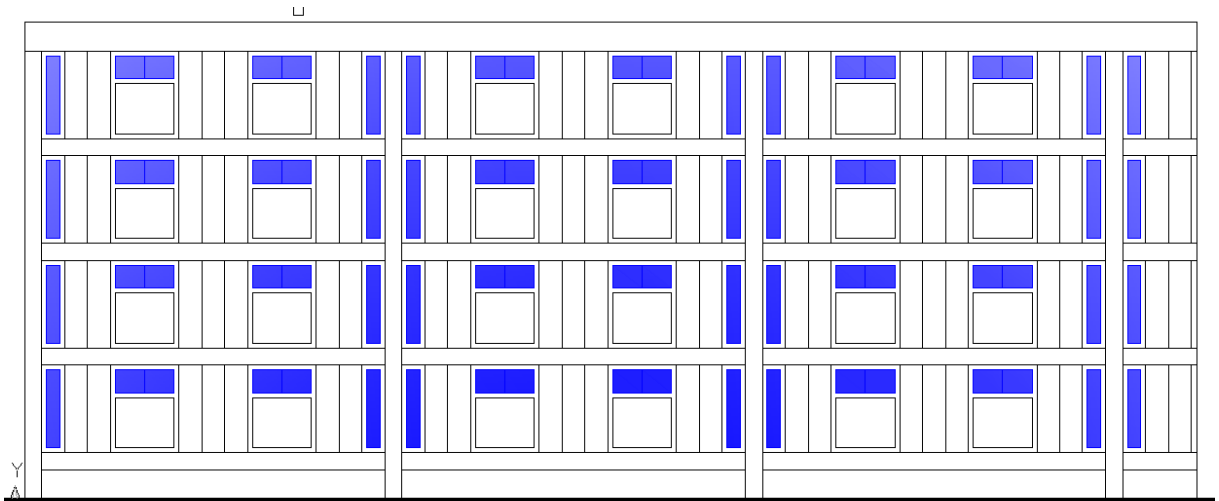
Façade Nord (place de la cité les Bananiers) dessinée sur Autodesk-Autocad.
